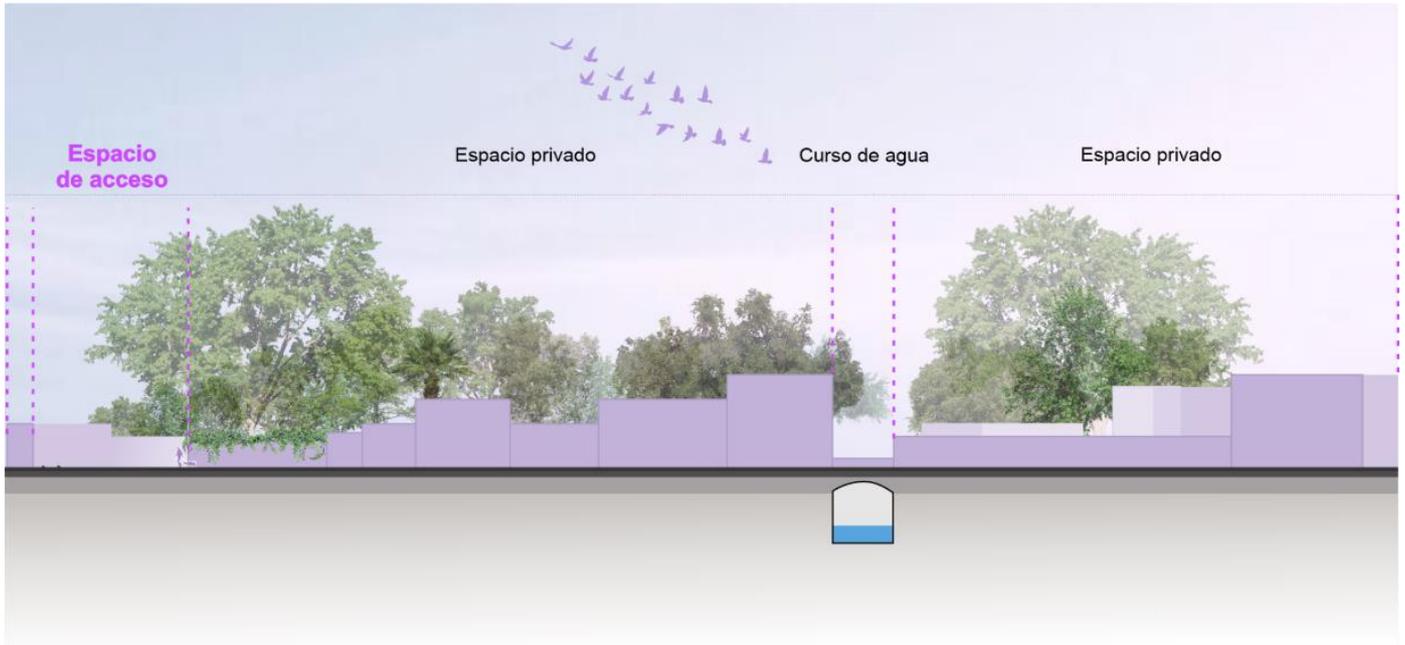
Fachada completa de vereda calle 8 de Octubre, entre calle Joaquín Suarez y Amorín. Elaboración propia.
